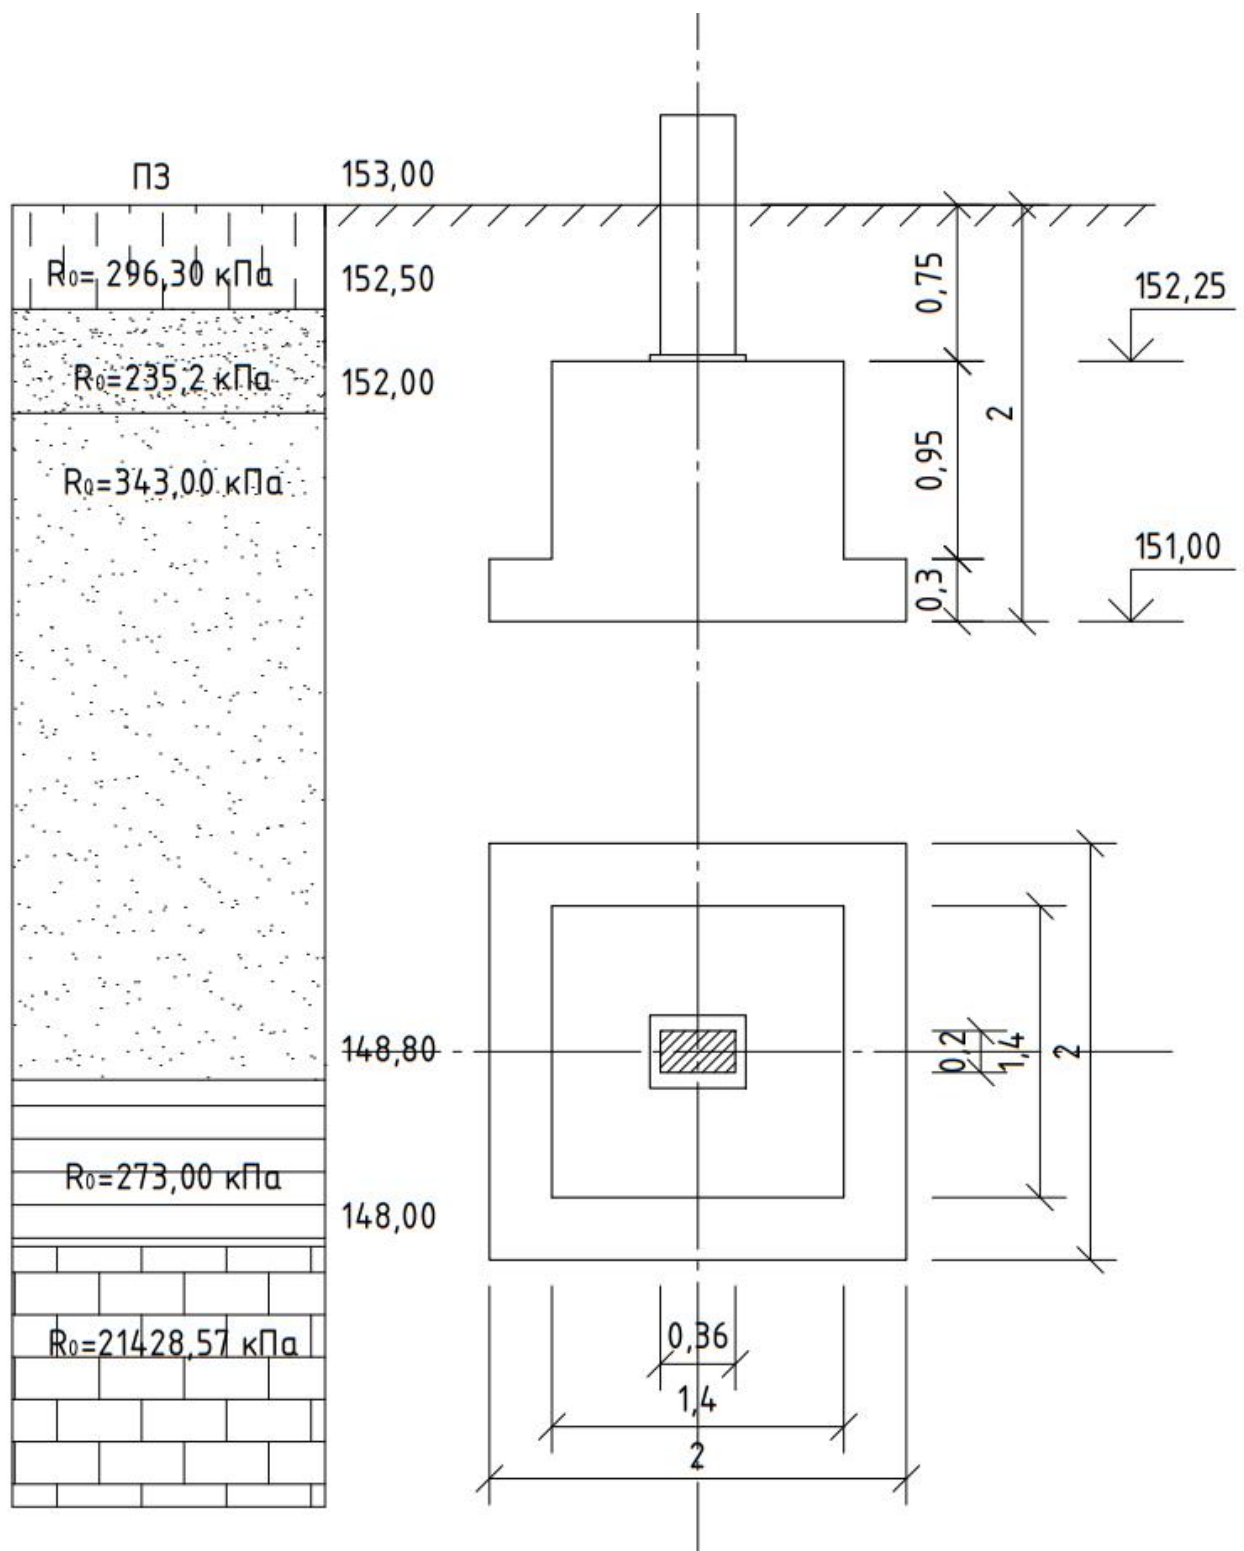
Схема до розрахунку фундаменту мілкового закладання
